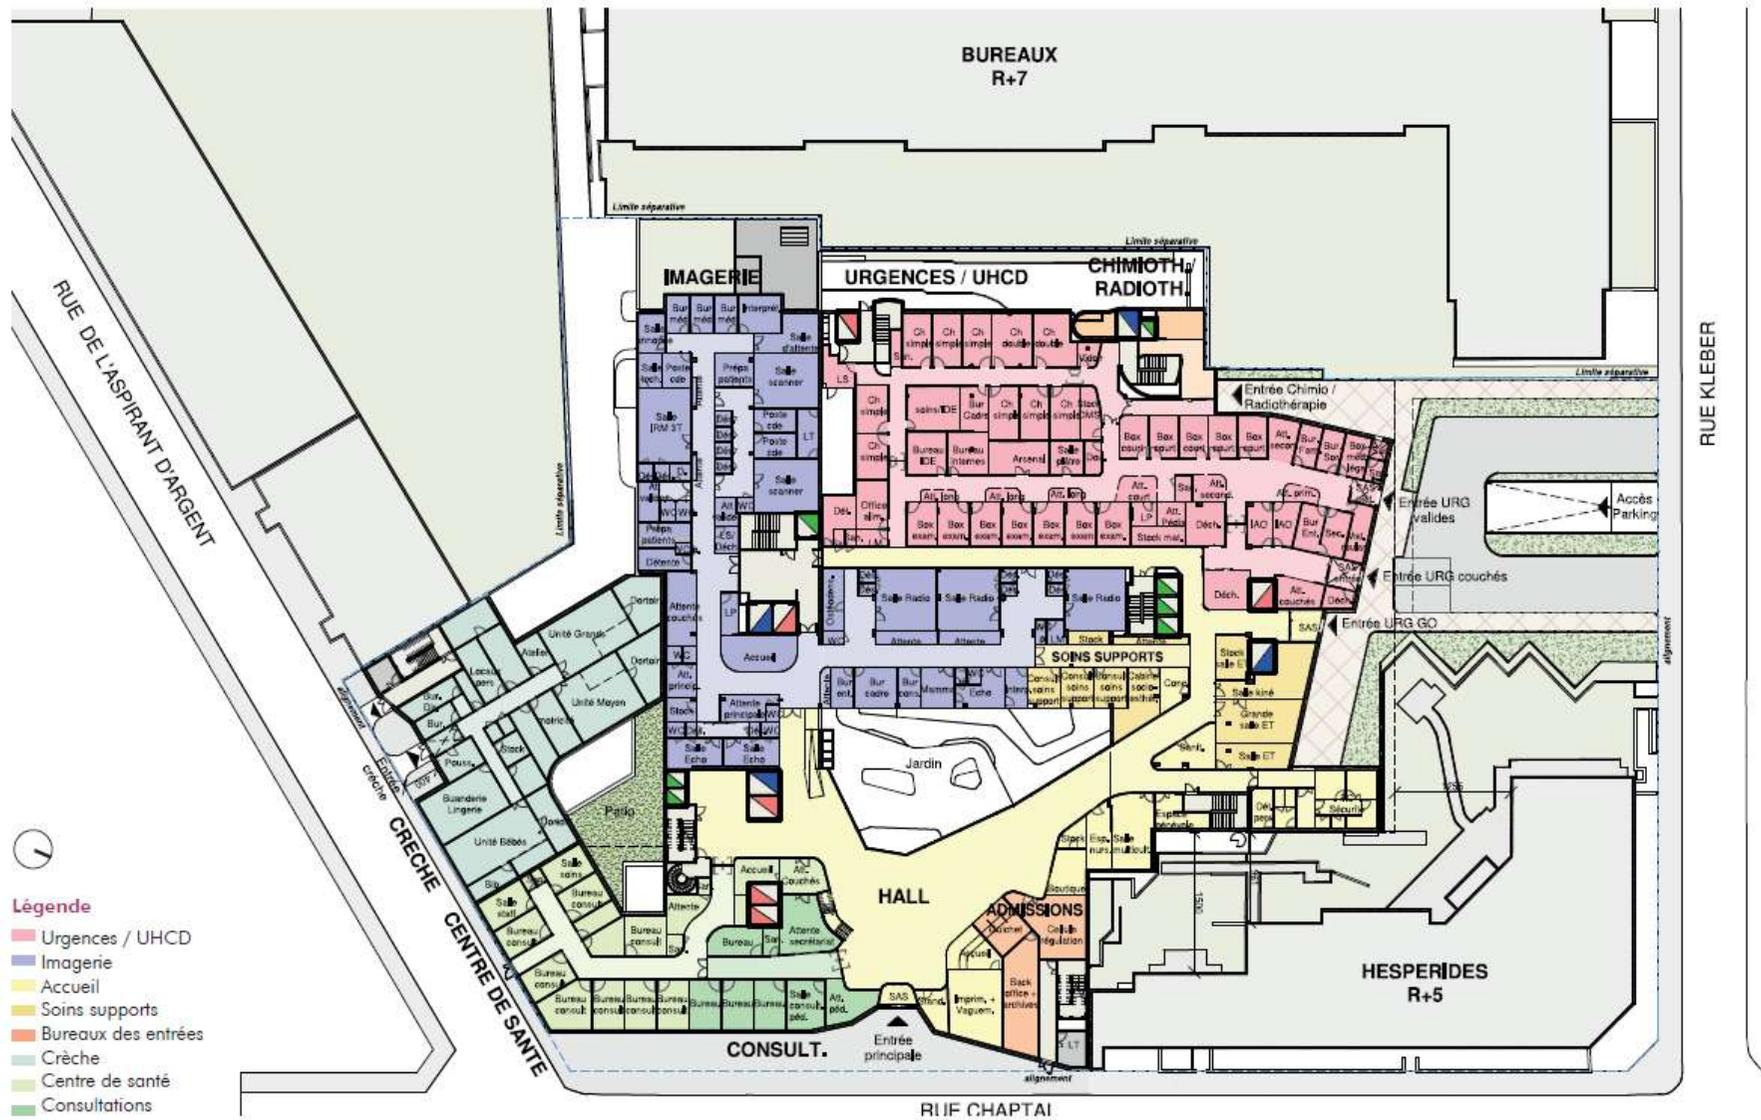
Plan du rez-de-chaussée (source : ISMS)
